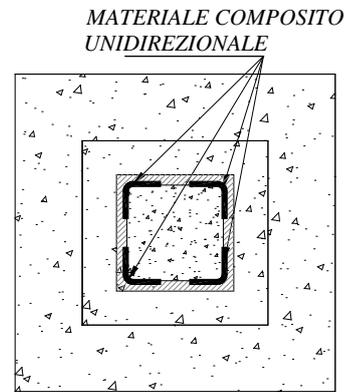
Applicazione del materiale composito unidirezionale. Sezione orizzontale
